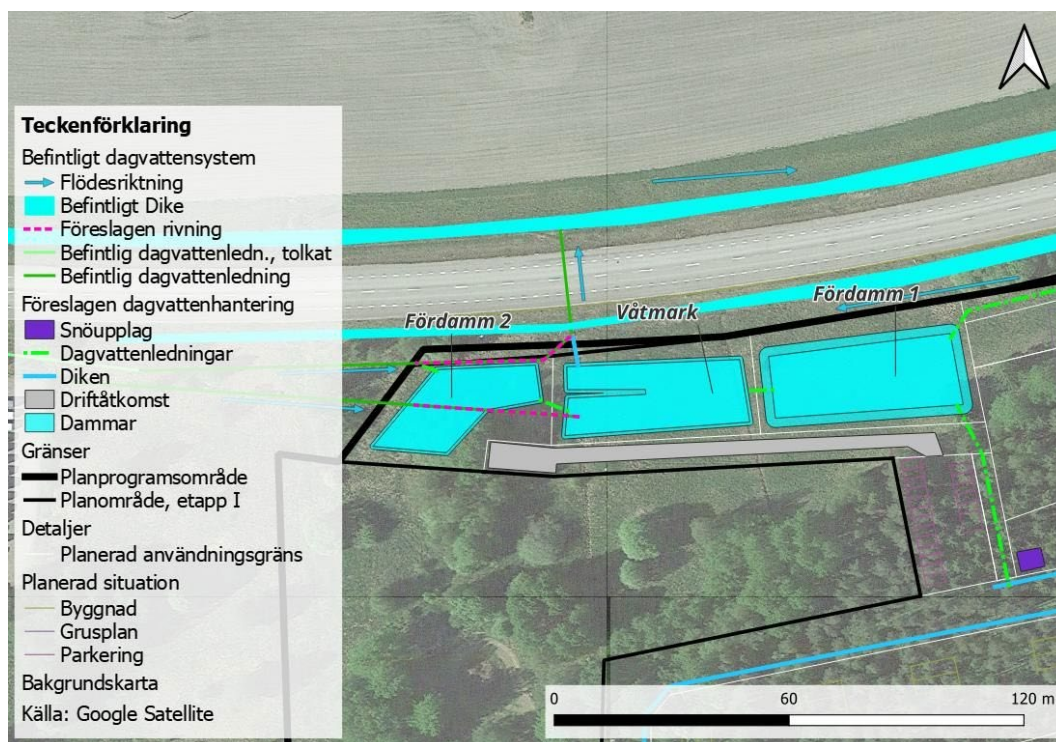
Planerad dagvattenhantering med diken, dammar och våtmark (Ramboll 2023).
